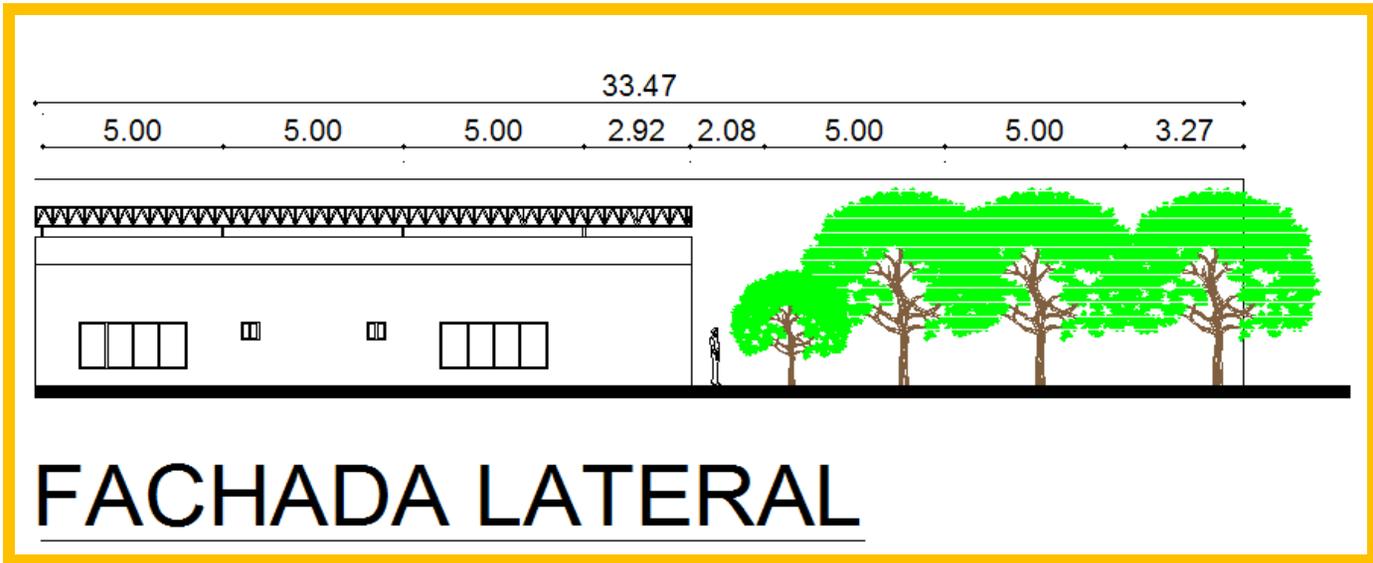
(fachada lateral-u.h. Emiliano Zapata)
